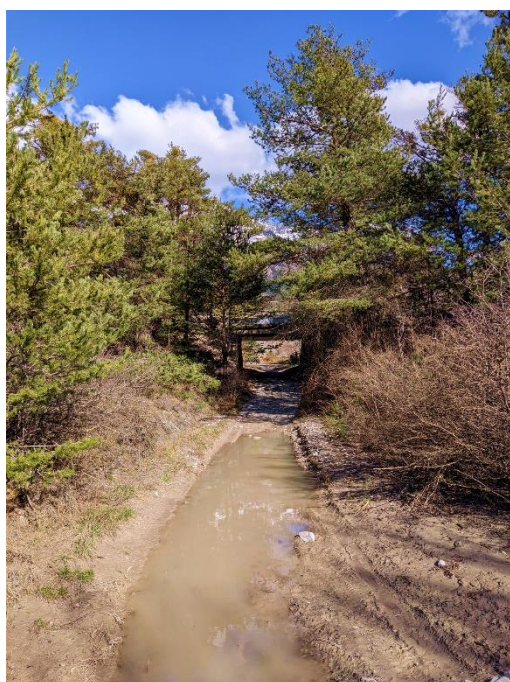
Ouvrage SNCF secondaire, situé un peu moins de 300 m en aval, en dessous de la sablière
